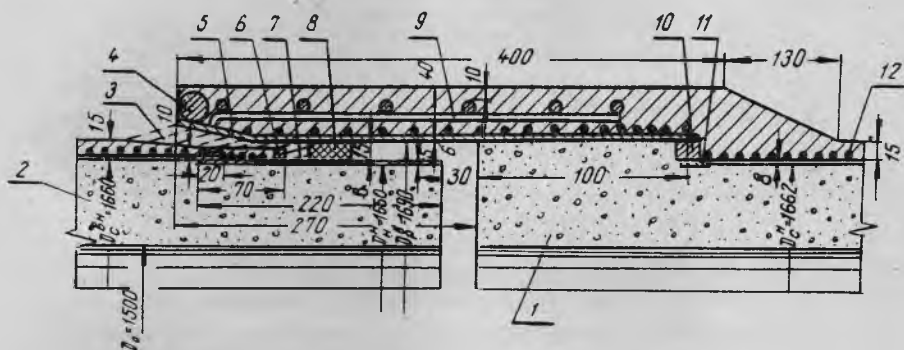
Гибкий раструбный стык сборных железобетонных трубопроводов конструкции ВОДГЕО:
